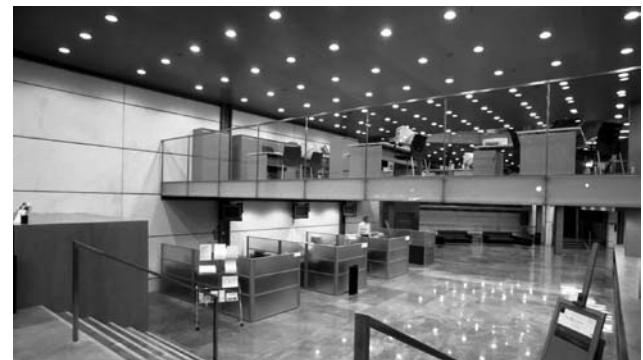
Pavimento de piedra Sierra Elvira en cota de acceso
